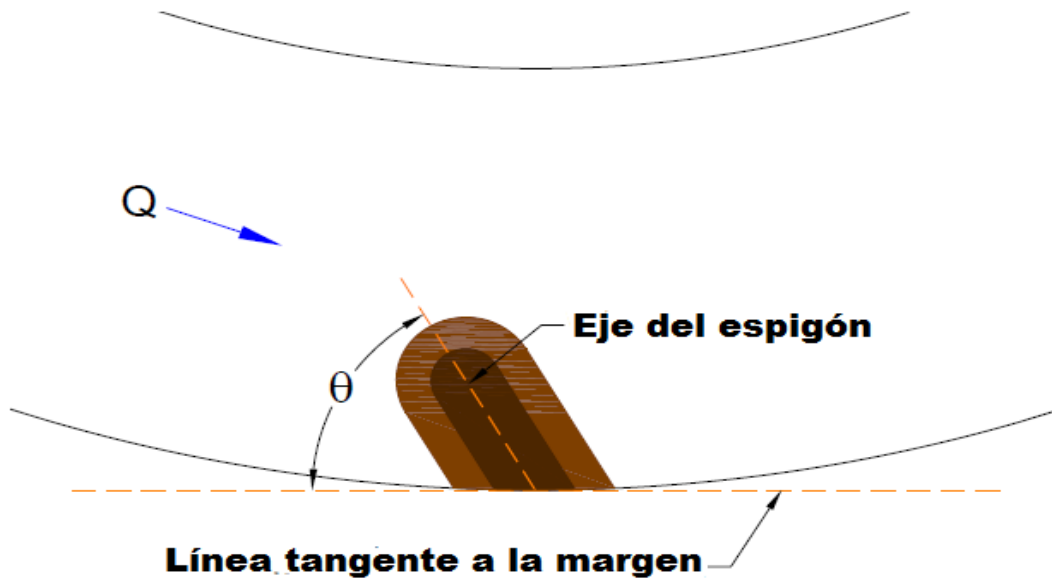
Ilustración del ángulo en planta del espigón y su incremento
